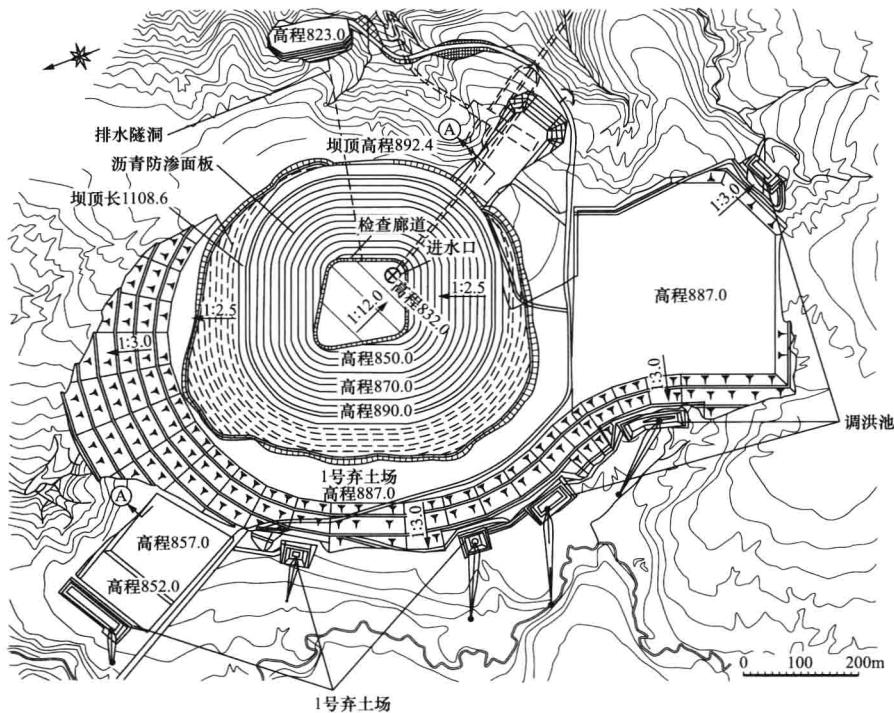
京极抽水蓄能电站上水库平面图 (单位: m)
